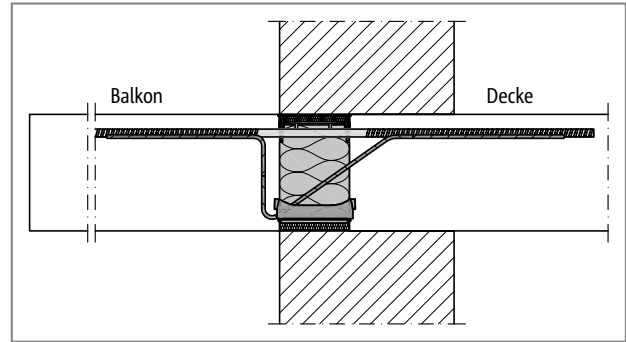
Schöck Isokorb® CXT Typ K: Anschluss bei einschaligem Mauerwerk
